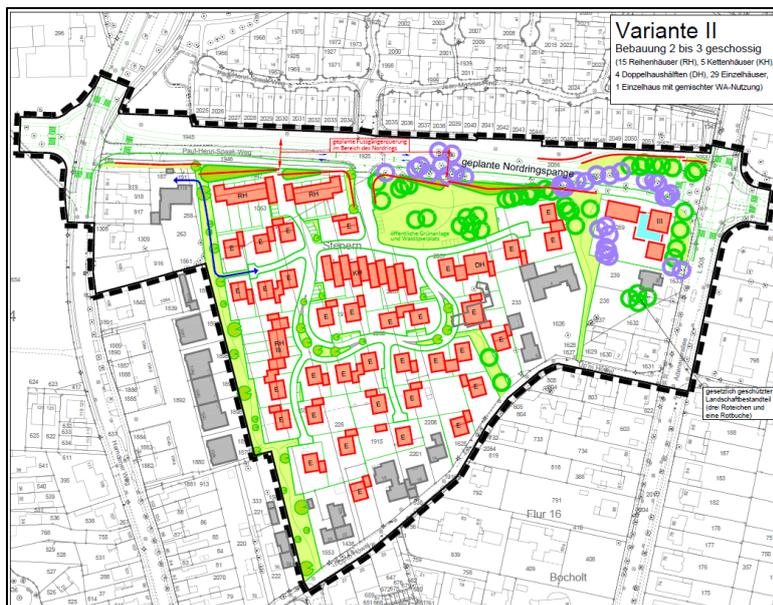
Bauungsplan 2 zum Bebauungsplan 10-7
